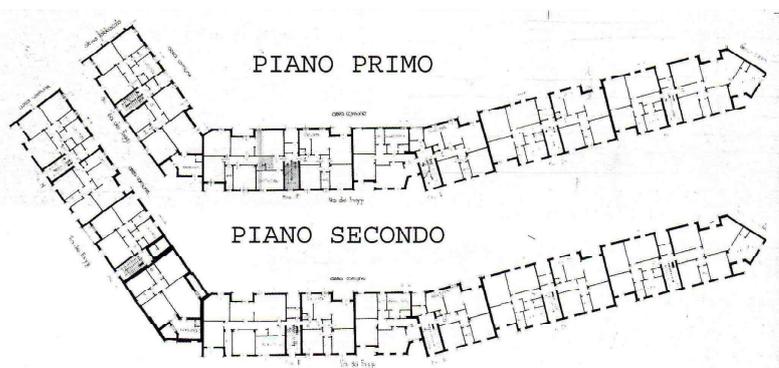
Blocco 40, piante del primo e del secondo piano
